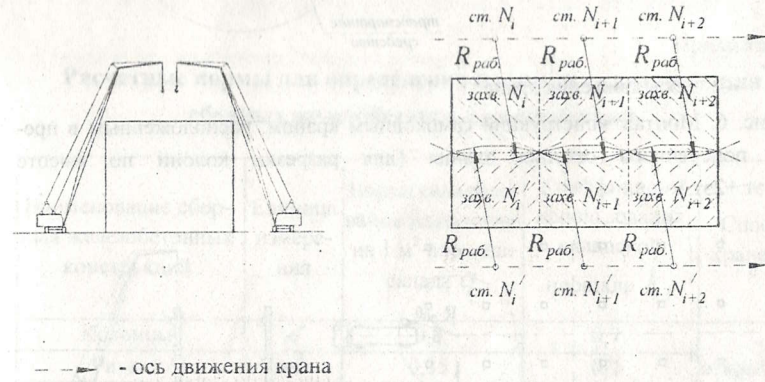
Монтаж железобетонных конструкций двумя самоходными кранами
